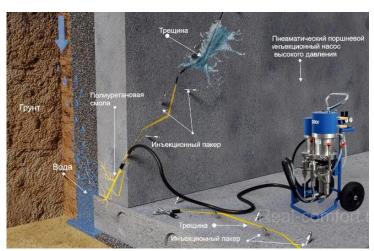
Восстановление гидроизоляции методом инъектирования
